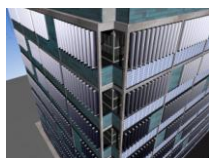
Trecho da fachada noroeste (com brises verticais e painéis fotovoltaicos) e da fachada nordeste
